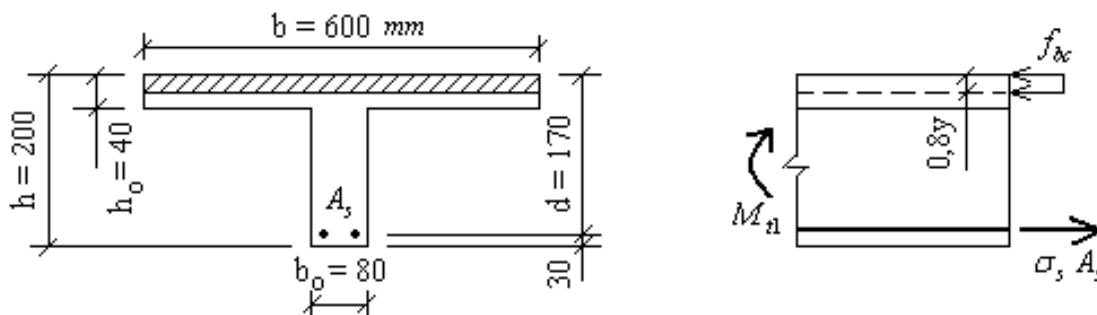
Schéma de calcul de la poutrelle dans la travée
